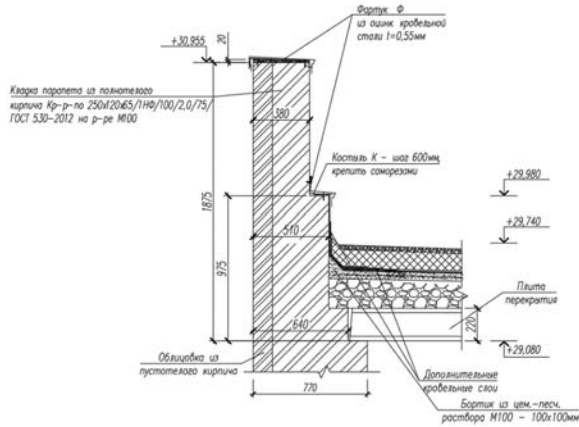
Узел кровли с наружной ограждающей конструкцией
